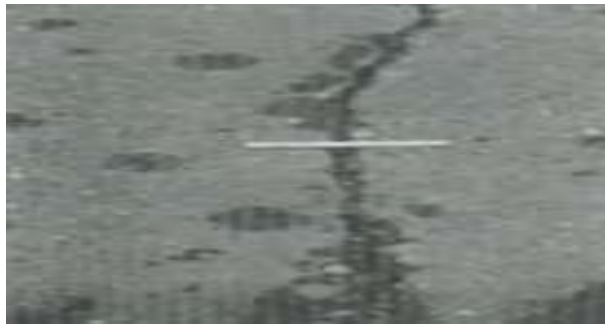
Grietas Lineales de Severidad Media en Losa de Concreto Simple.
